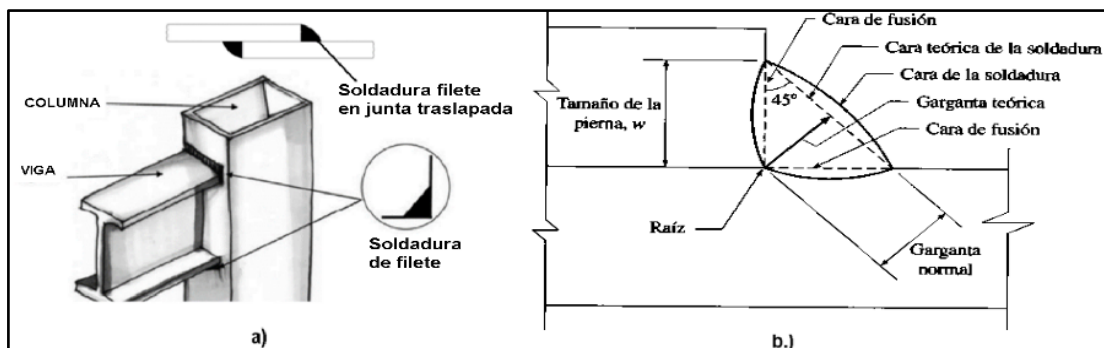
a) Detalle de soldadura tipo filete; b) Partes de una soldadura tipo filete. Vinnakota (2006)
